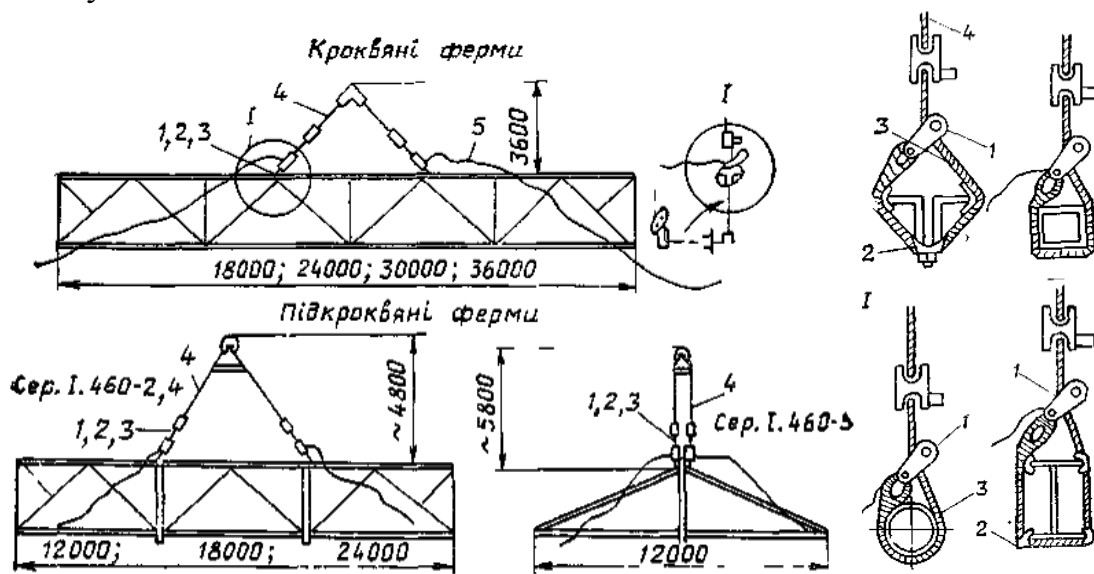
Стропування кроквяних і підкроквяних ферм:
